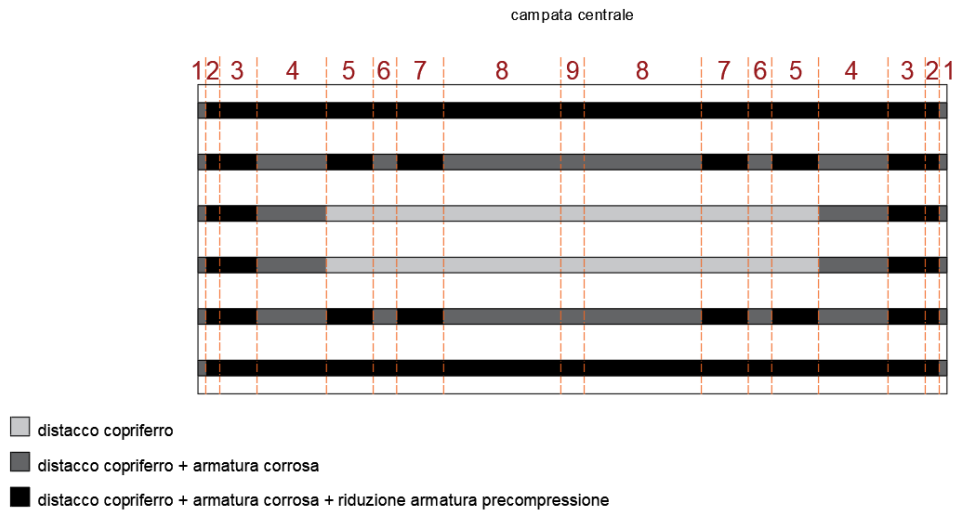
Ponte sul torrente Mavigliano, Caso I_ev5 schema deterioramento in pianta
